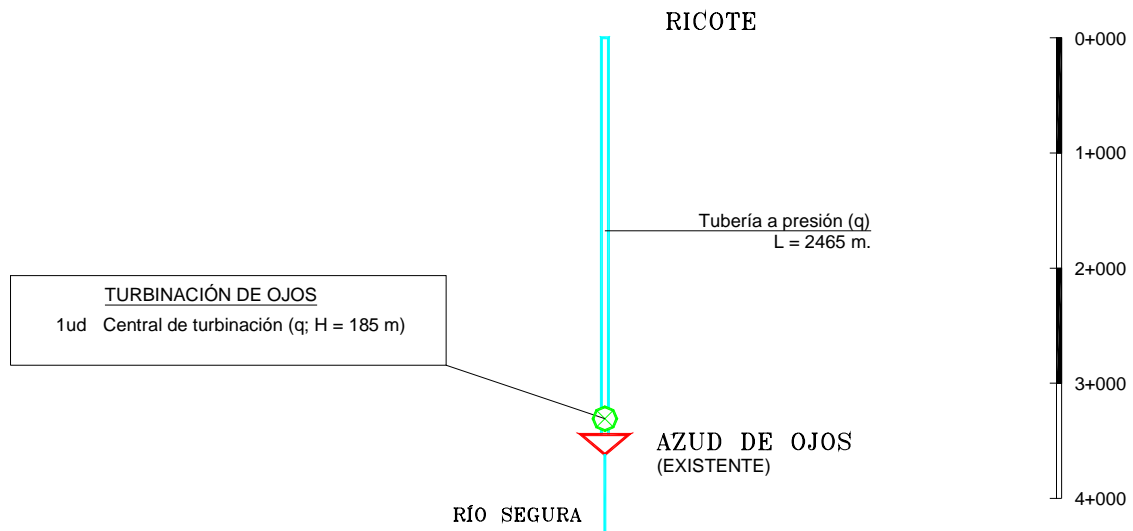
Conducción Ricote-Ojós. Esquema en planta
